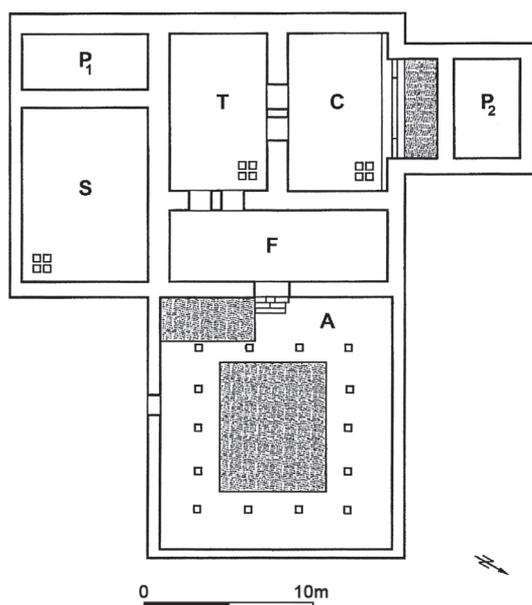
Grundrissplan Bauphase 1a. Das Apodyterium ist nach dem Vorbild des Legionsbades in Vindonissa rekonstruiert.
